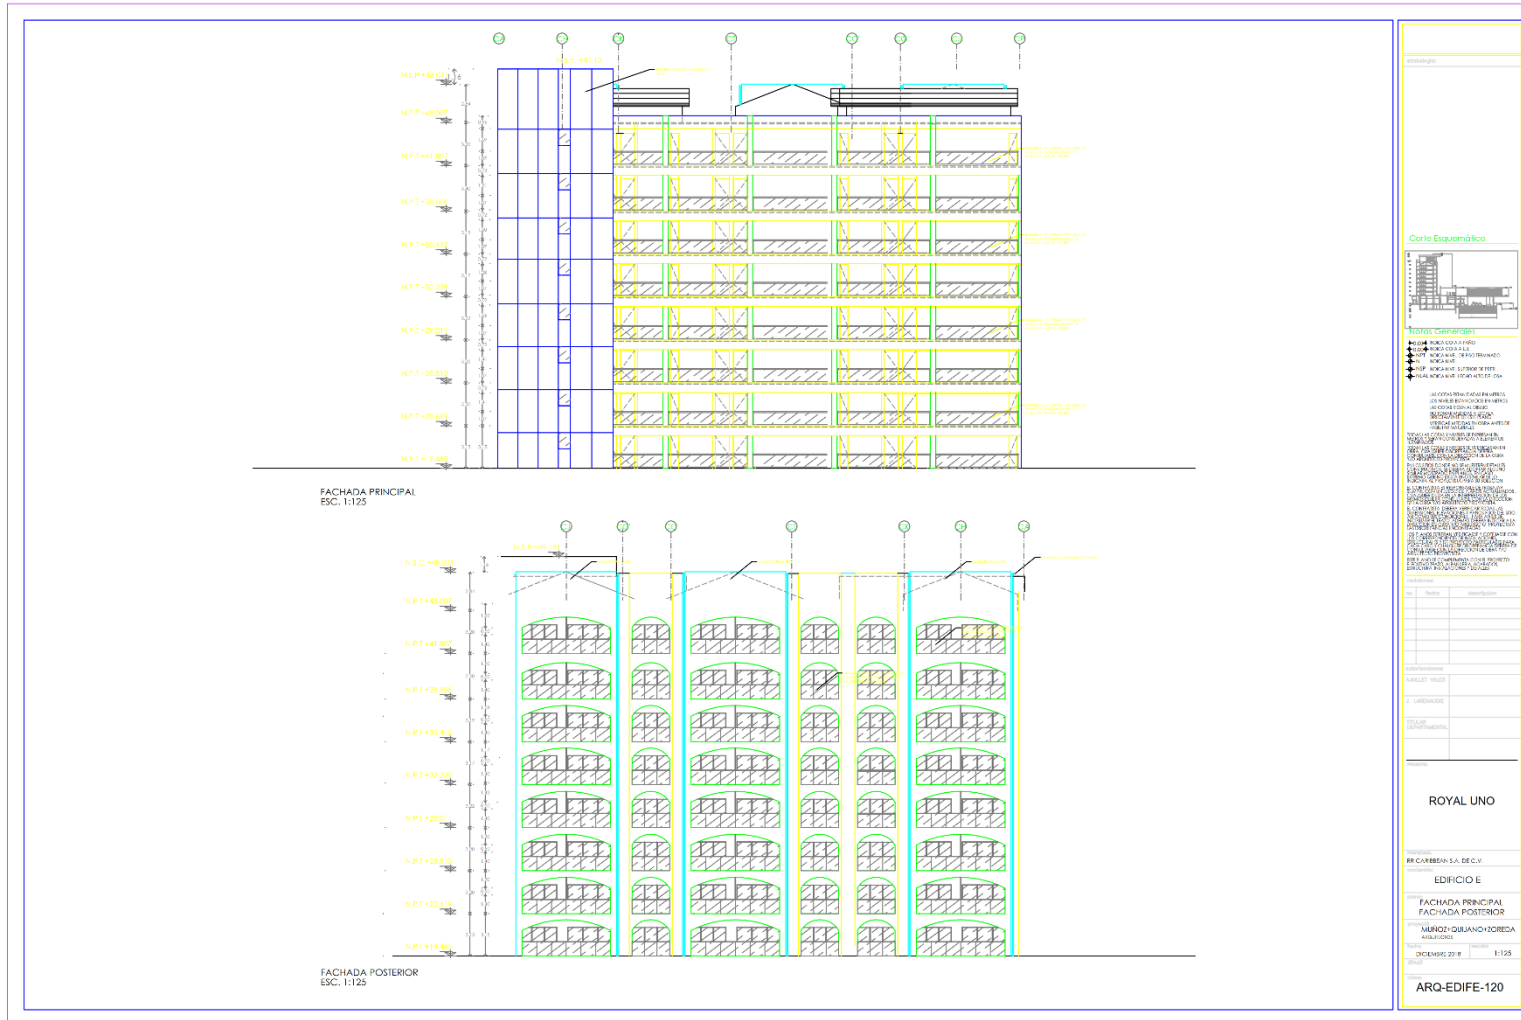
Edificio E, Fachada posterior y principal. Anexo C-7.
